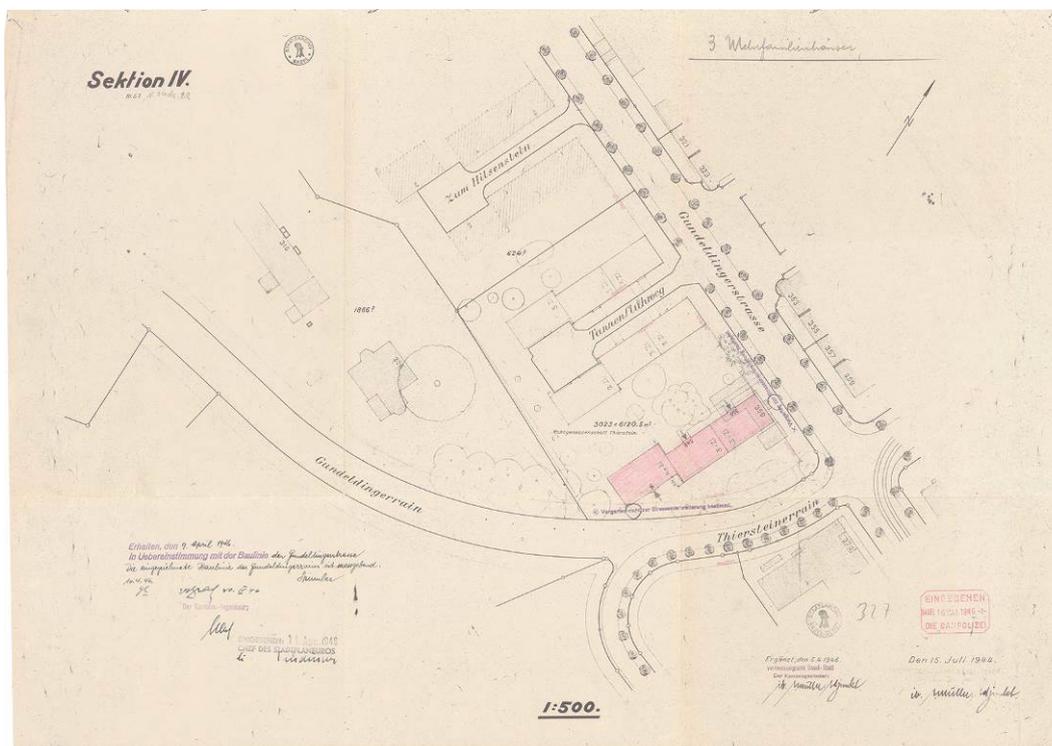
Baueingabeplan, Situation 1:500, Etappe 3, 1944. Architekturbüro Rudolf Christ, 15.6.1944 [Quelle: StaB]
